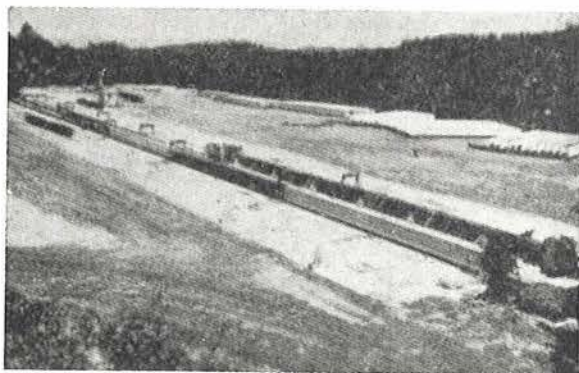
Banco de 500 pies con estribos móviles y bastidores.
